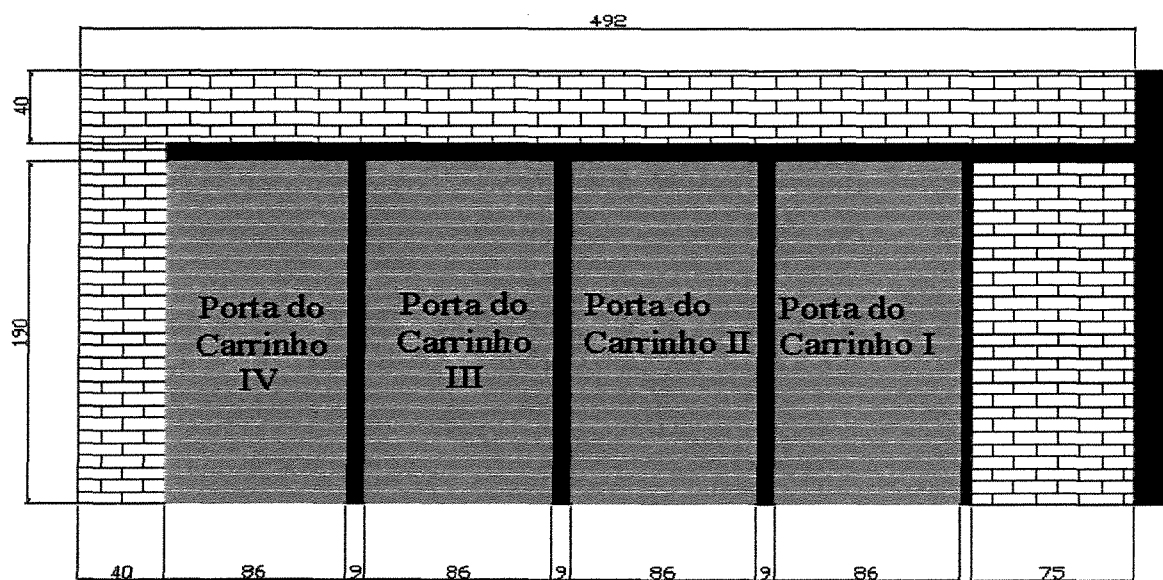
Câmara de secagem (cotas em cm) Corte AB.
